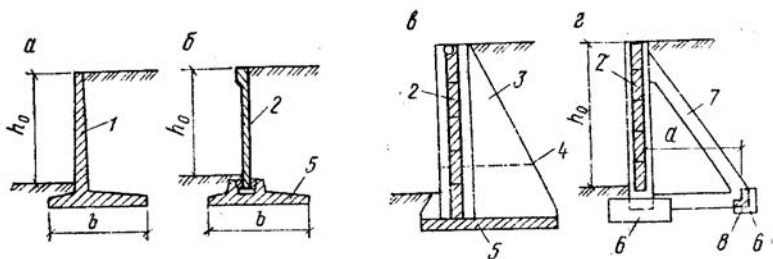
Конструктивные схемы сборных подпорных стен
